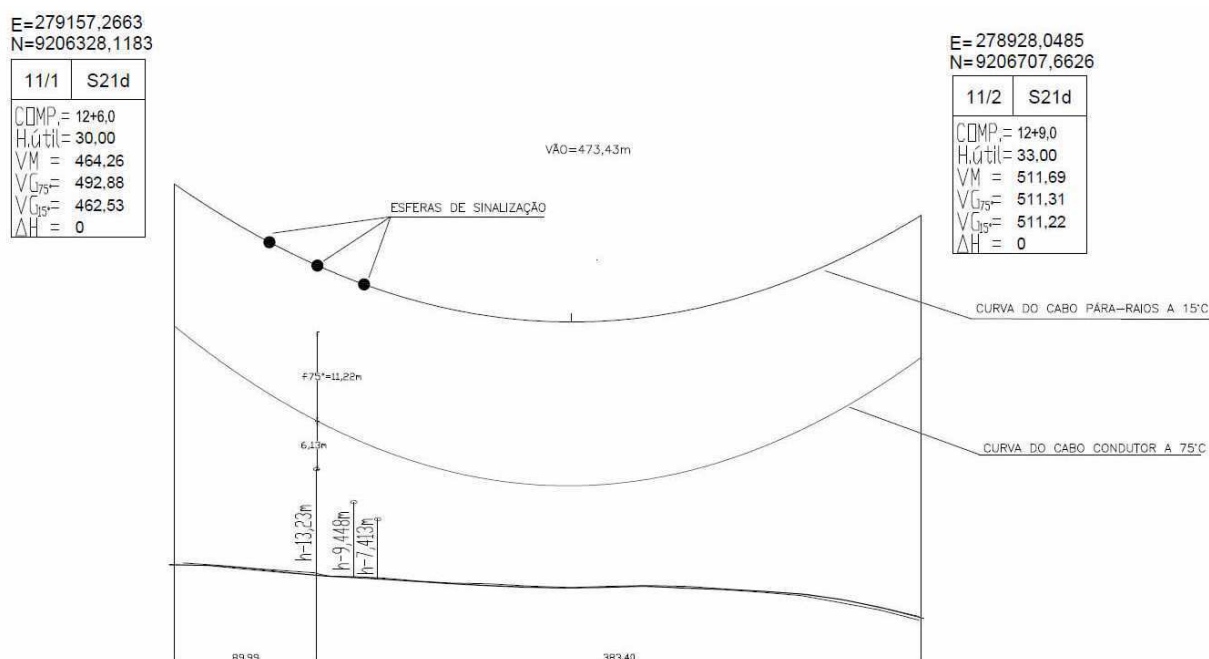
Perfil da LT para a travessia sobre as LTs 13,8 kV e 69 kV no vão entre as estruturas 11/1 e 11/2 (Chesf, 2010).
